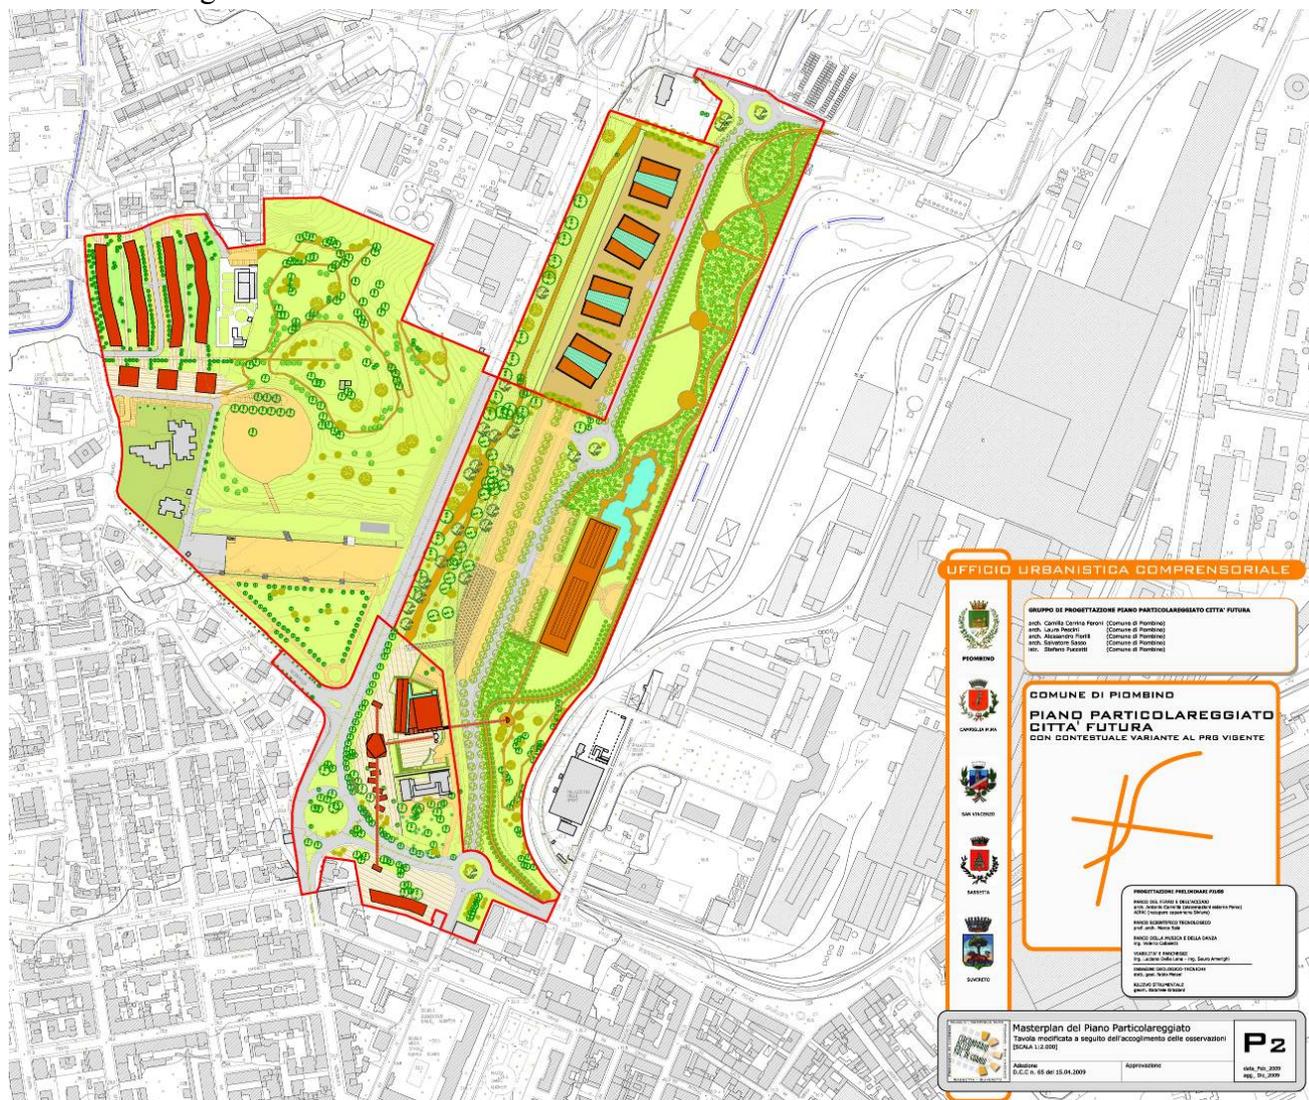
estratto masterplan piano particolareggiato “Città Futura”
